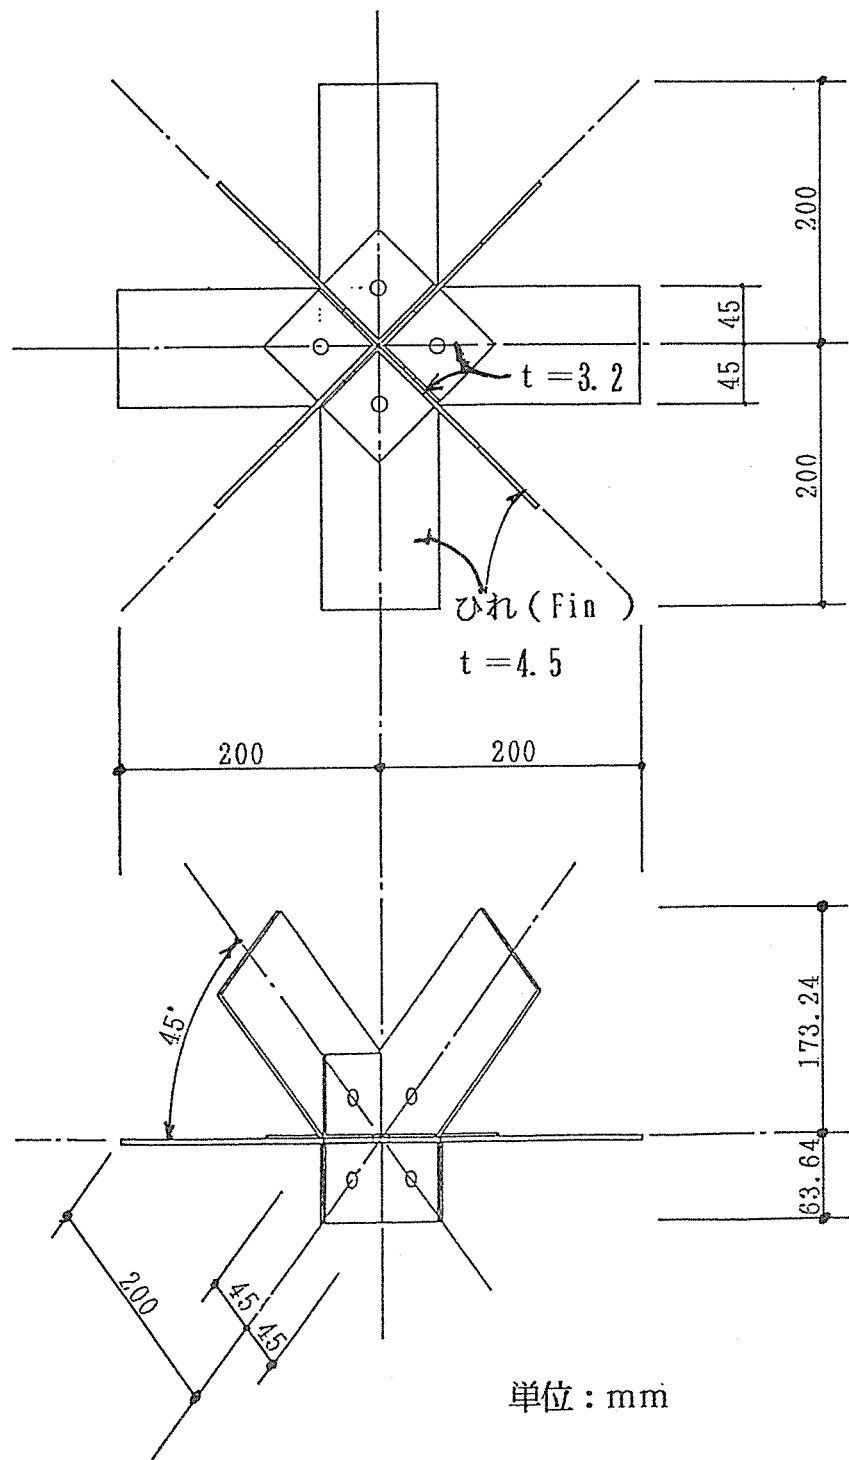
ノードレス式接合金物 NLJ 平面及び立面図
